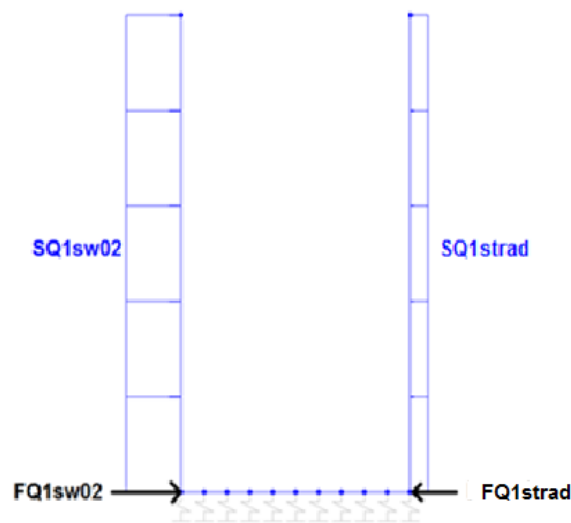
Condizione di carico SPACCSXSW/02 e SPACCDXstrad da SAP2000
